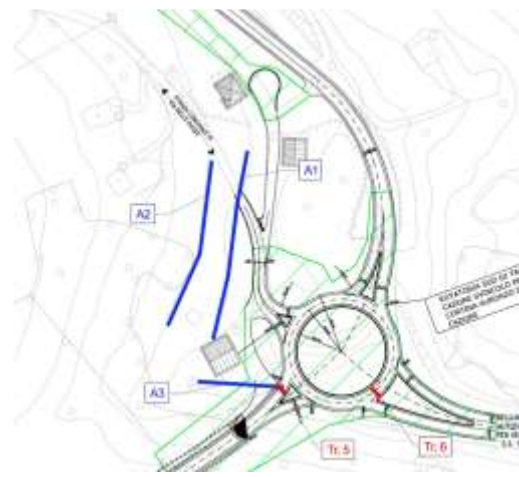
Stralcio planimetria ubicazione indagini: dettaglio Svincolo Tai Est
